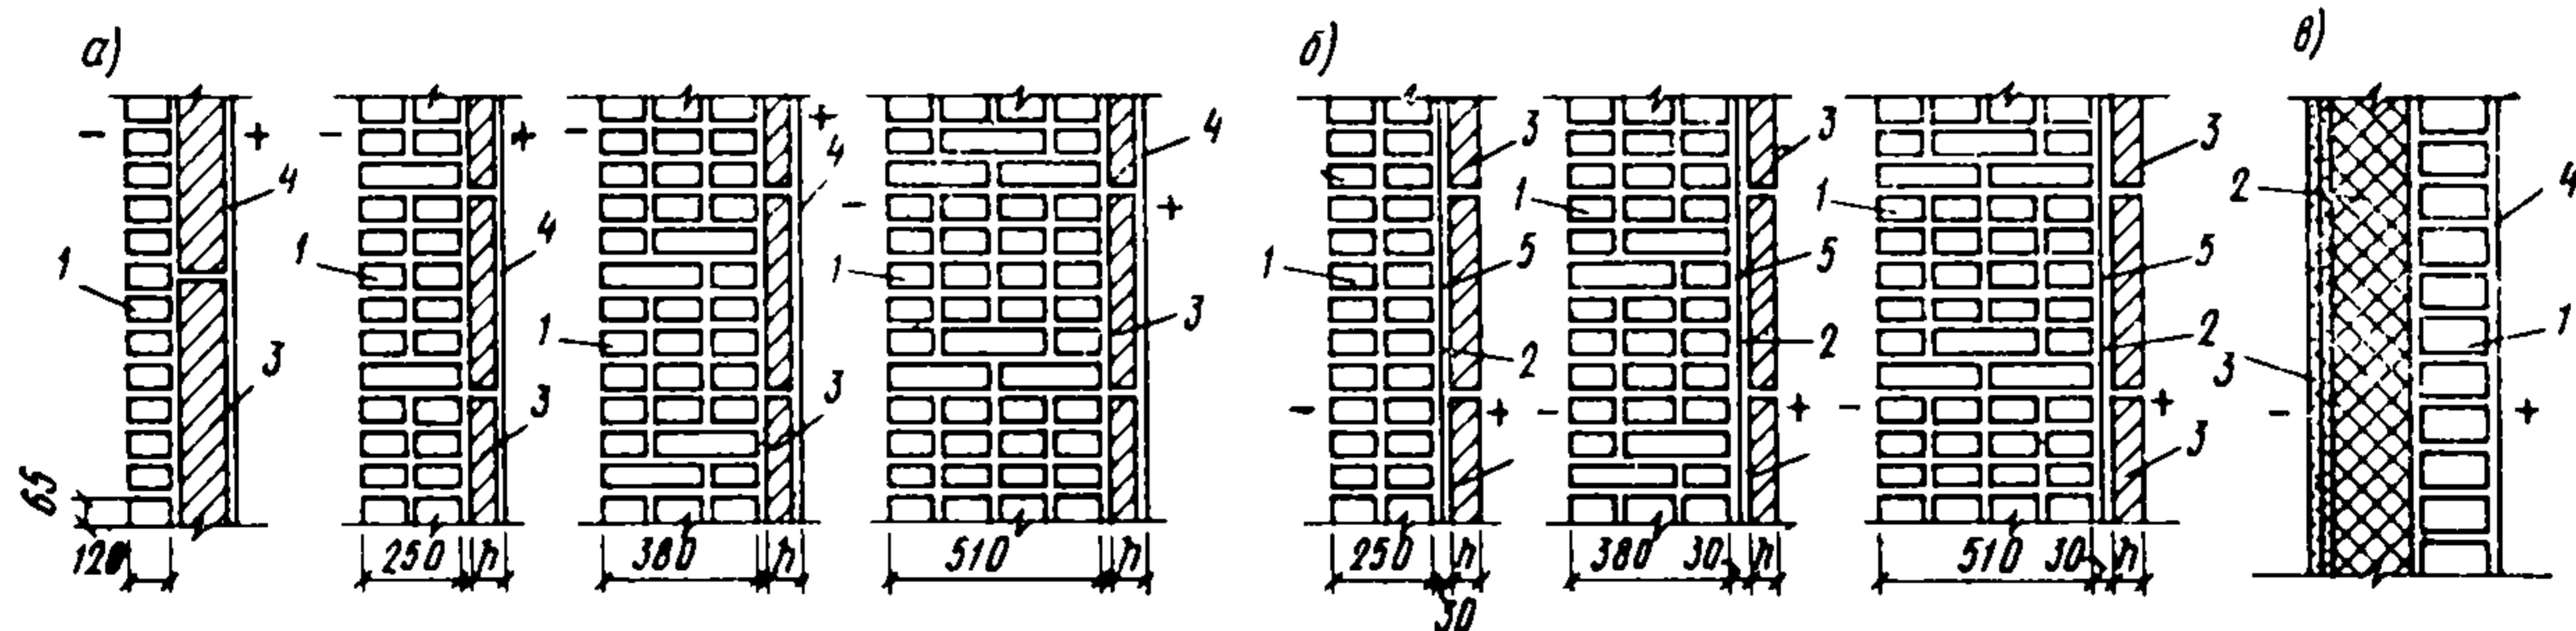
Кладка с теплоизоляционными плитами, расположенными у поверхностей стен
